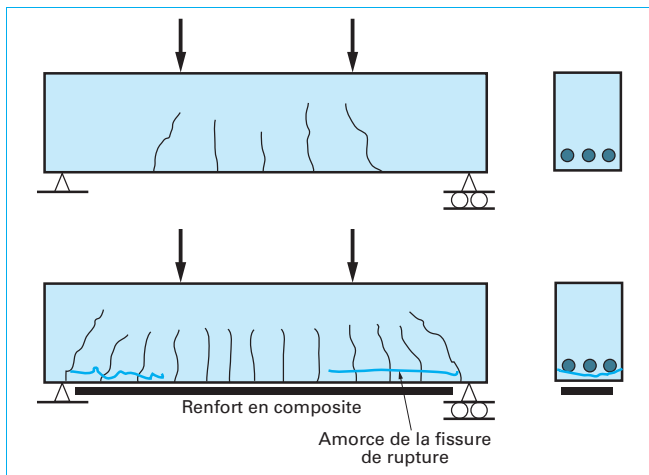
Comportements à rupture comparés d'une poutre témoin et d'une poutre renforcée par composite
